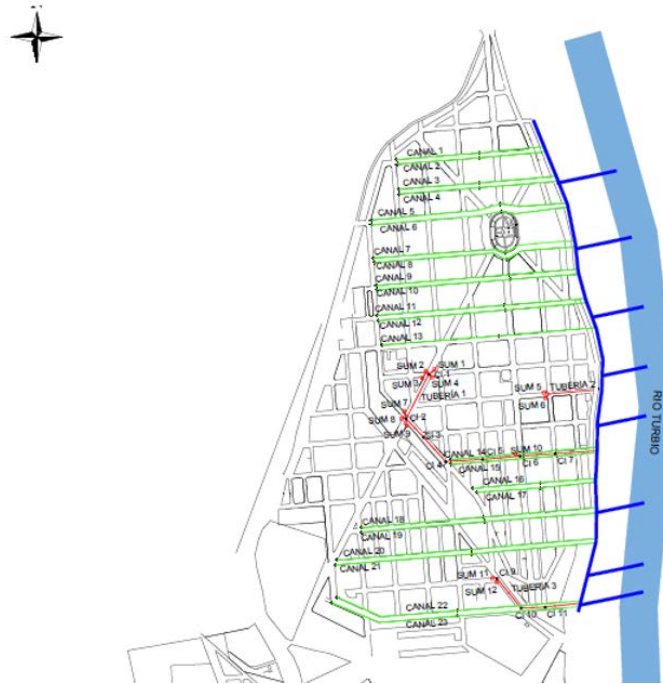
Esquema de Sistema propuesto para drenaje pluvial
